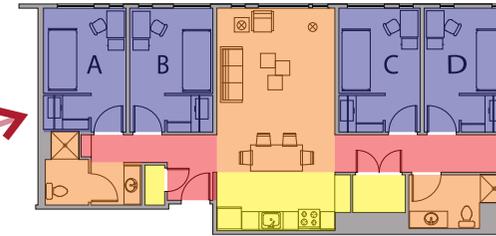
Planta Baixa - Tipo Coletivo
